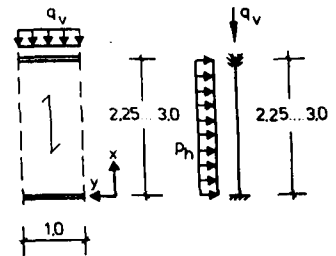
Horizontale Traglasten durch betonstahlbewehrte Ergänzungsschichten verstärkter, einachsig lastabtragender Mauerwerkswände: Variation des Verstärkungsumfanges und der Wandabmessungen
